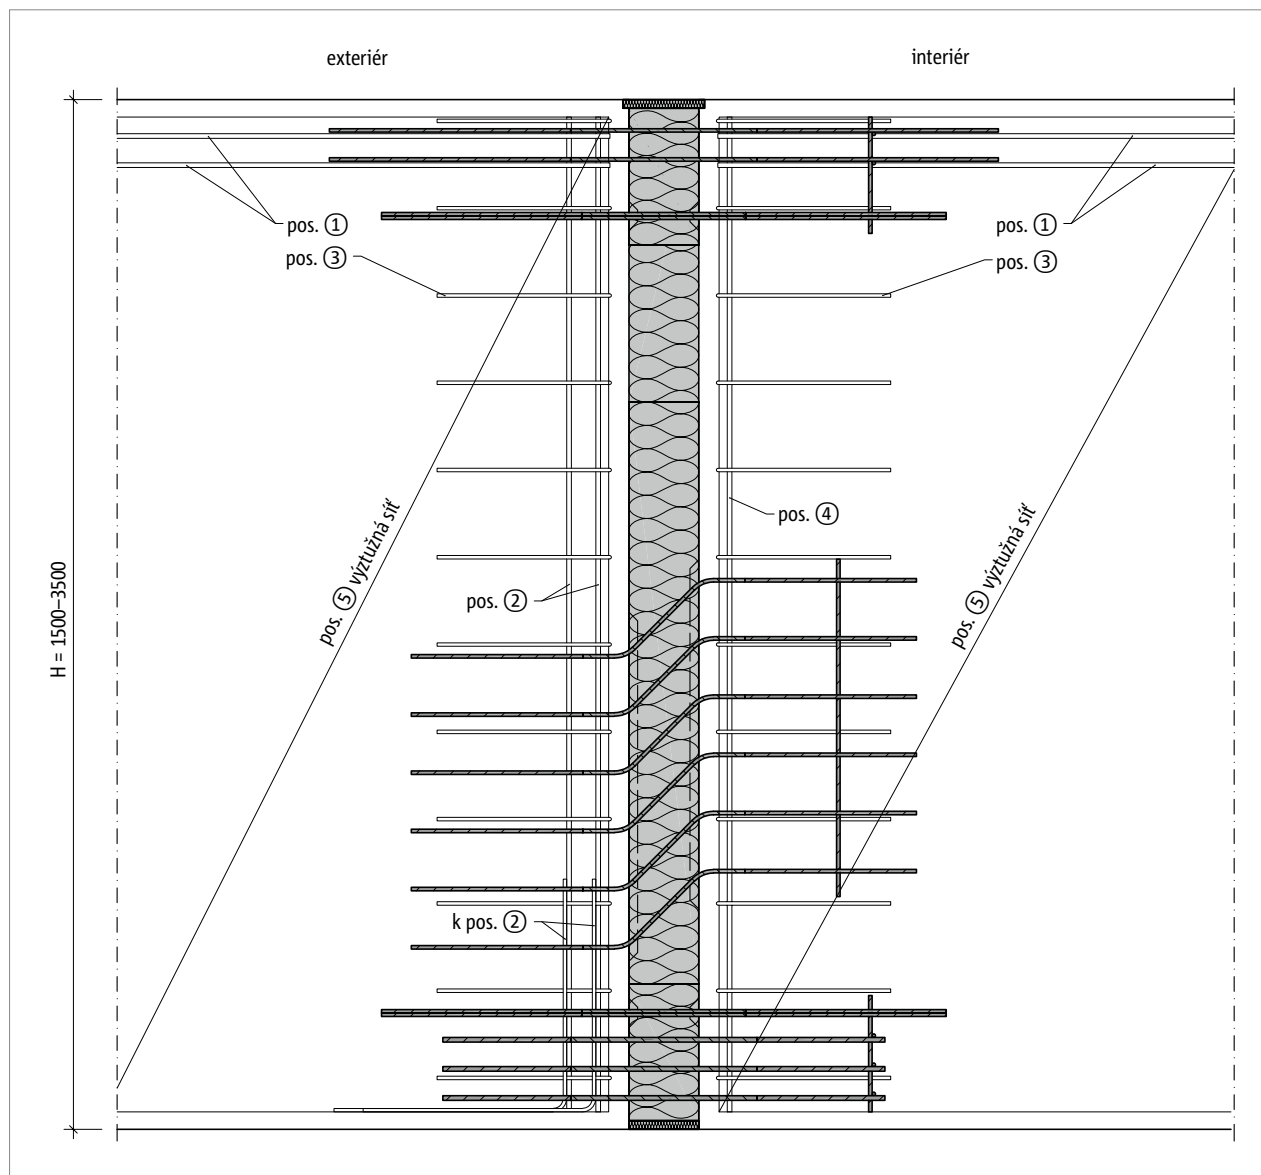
Schöck Isokorb® XT typ WL-M4: Půdorys prvku
